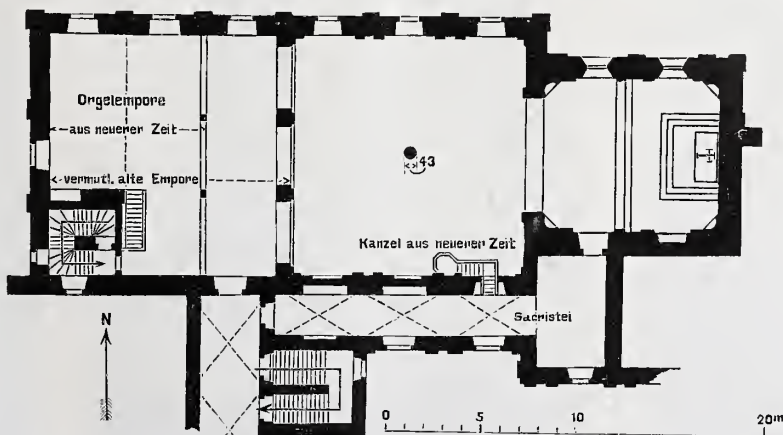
Grundriss des gegenwärtigen Kirchenraumes im 1. Stock.
